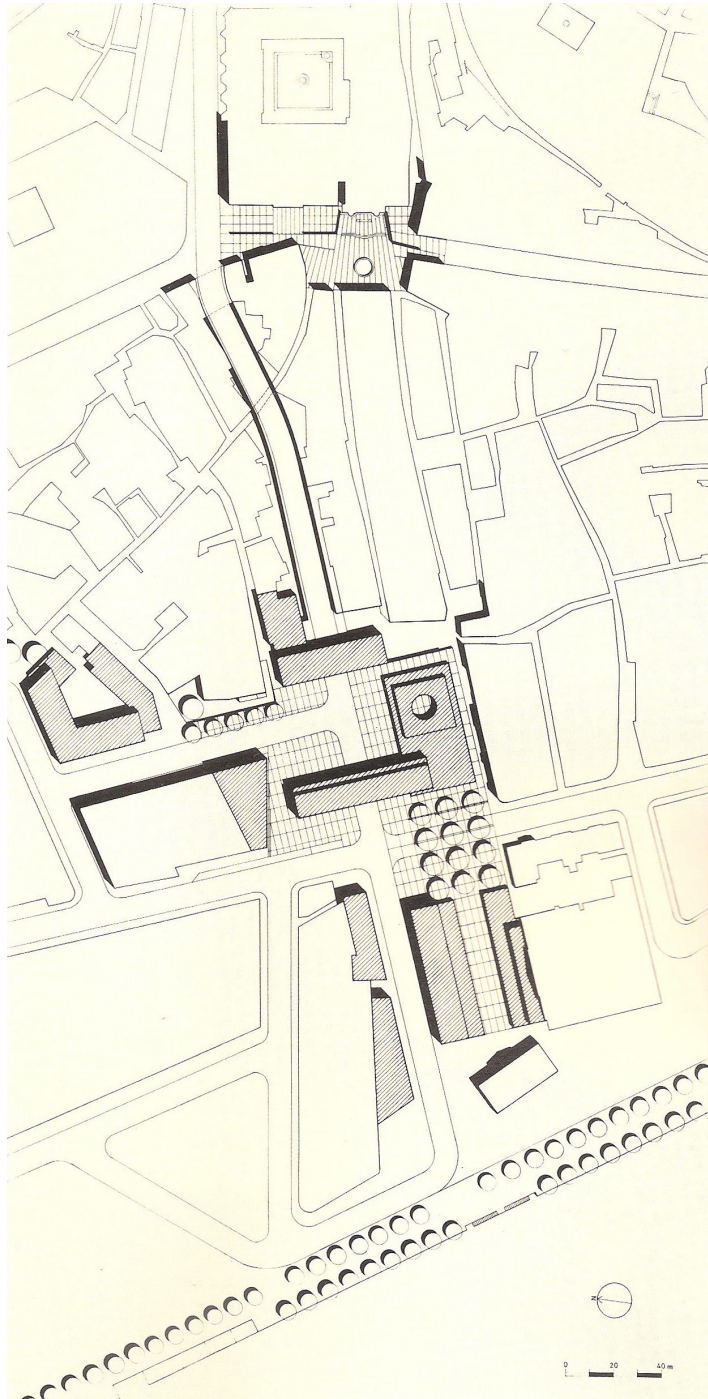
Plano de Pormenor Eixo Praça 8 de Maio - Rio - Fernando Távora
